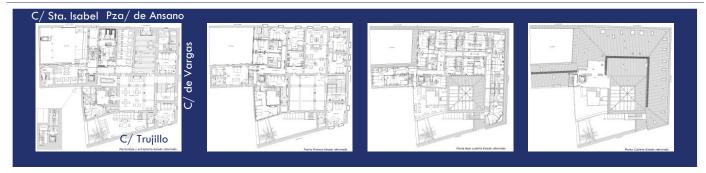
Plantas del estado reformado del edificio histórico Palacio Carvajal/Girón.
